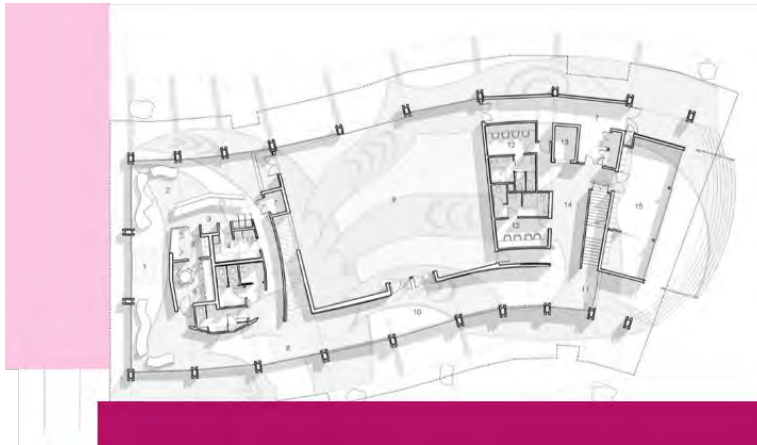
Planta baja de TE ORO. Imagen: [<http://www.archdaily.com/794648/te-oro-archimedia>, FECHA DE CONSULTA SEP/2016]
